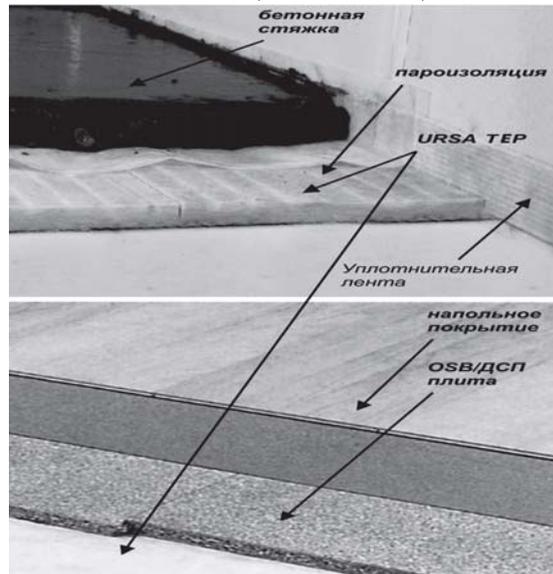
Схема тепло, звукоизоляция междуэтажного перекрытия “под стяжку”
